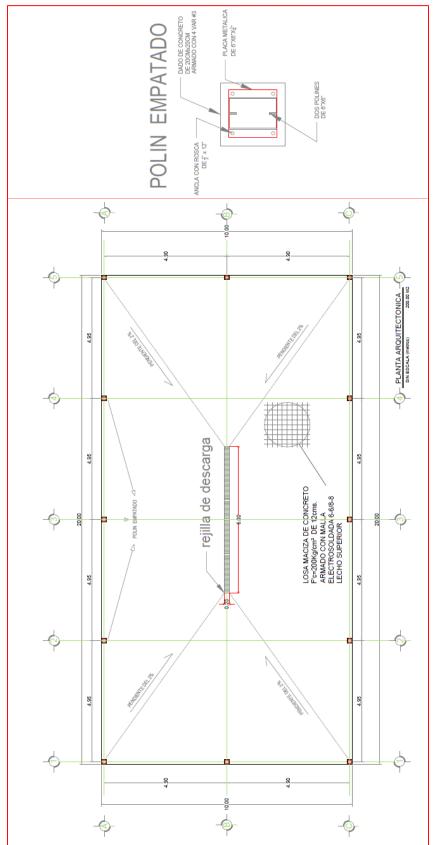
Planta arquitectónica de la nave de servicio para la planta de OI.
